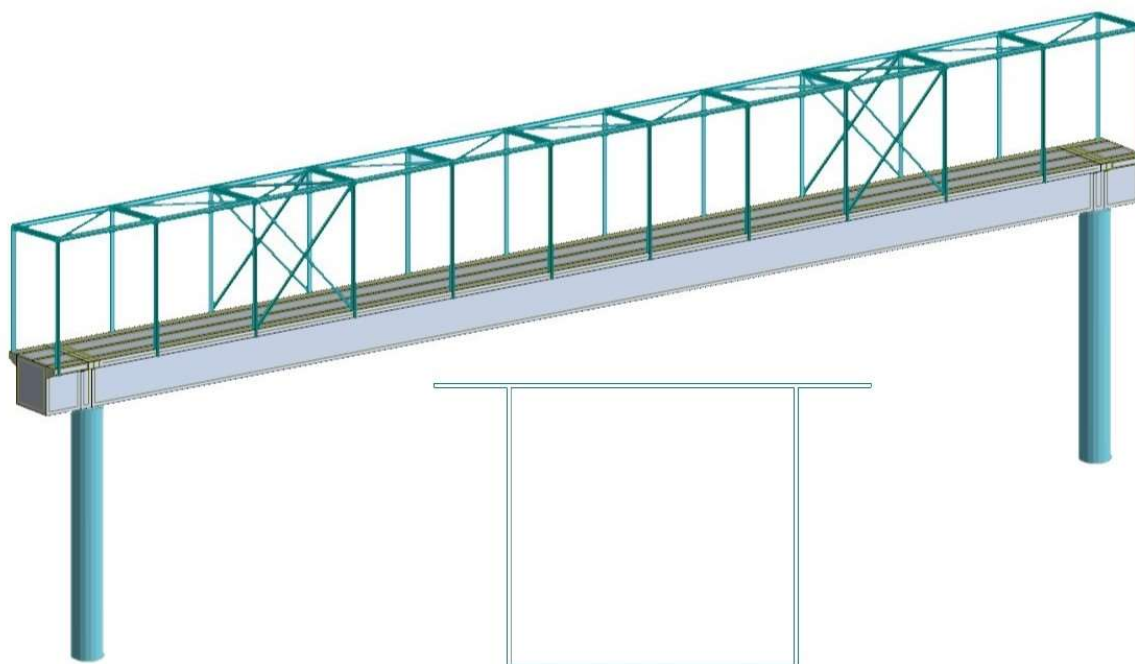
Esquema estrutural do passadiço e secção transversal do tabuleiro
